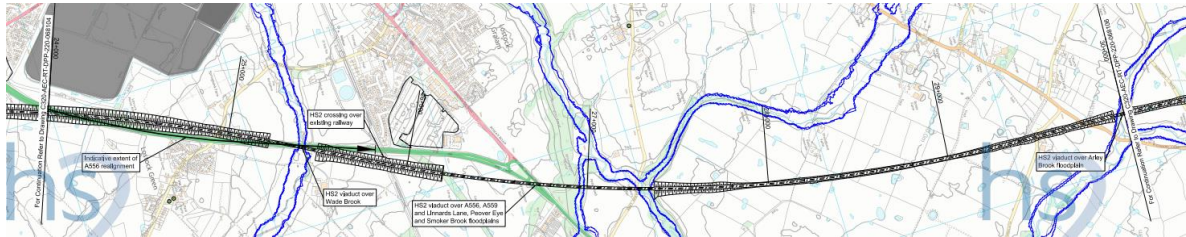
Planta do traçado viaduto sobre A556, A559 e Linnards Lane (Unido, HS2 Phase 2b: Chorlton to Winterbottom route sheet 5).
